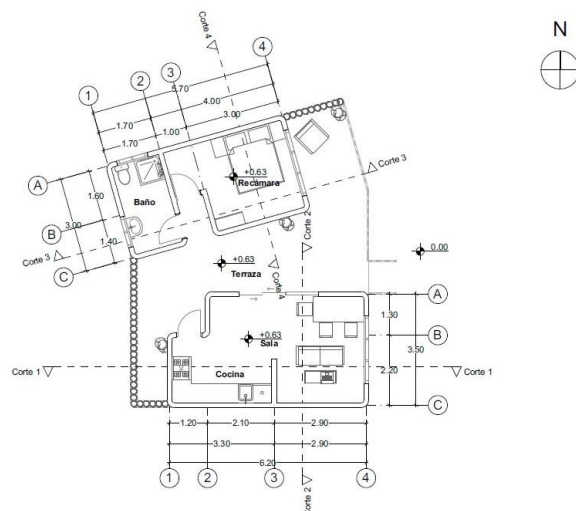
Plano Arquitectónico 66.84 M². Elaboración Propia
